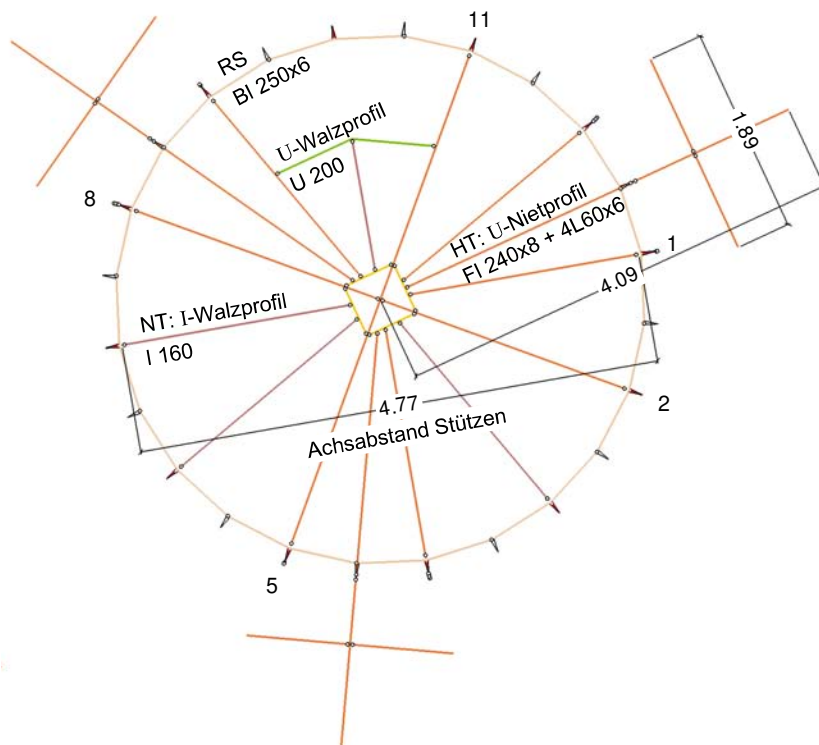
Grundriss Decke über Küche mit Querschnittsbezeichnungen
